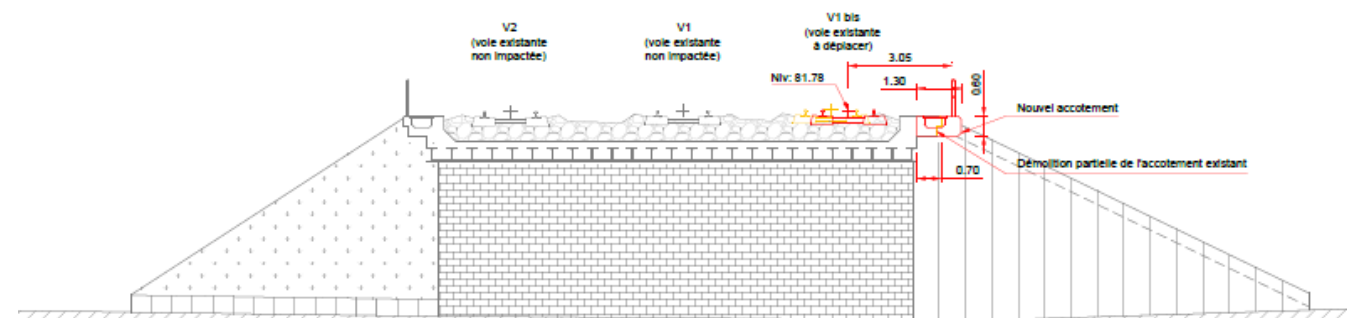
Principe d'aménagement du pont-rail du Boulevard de Strasbourg
